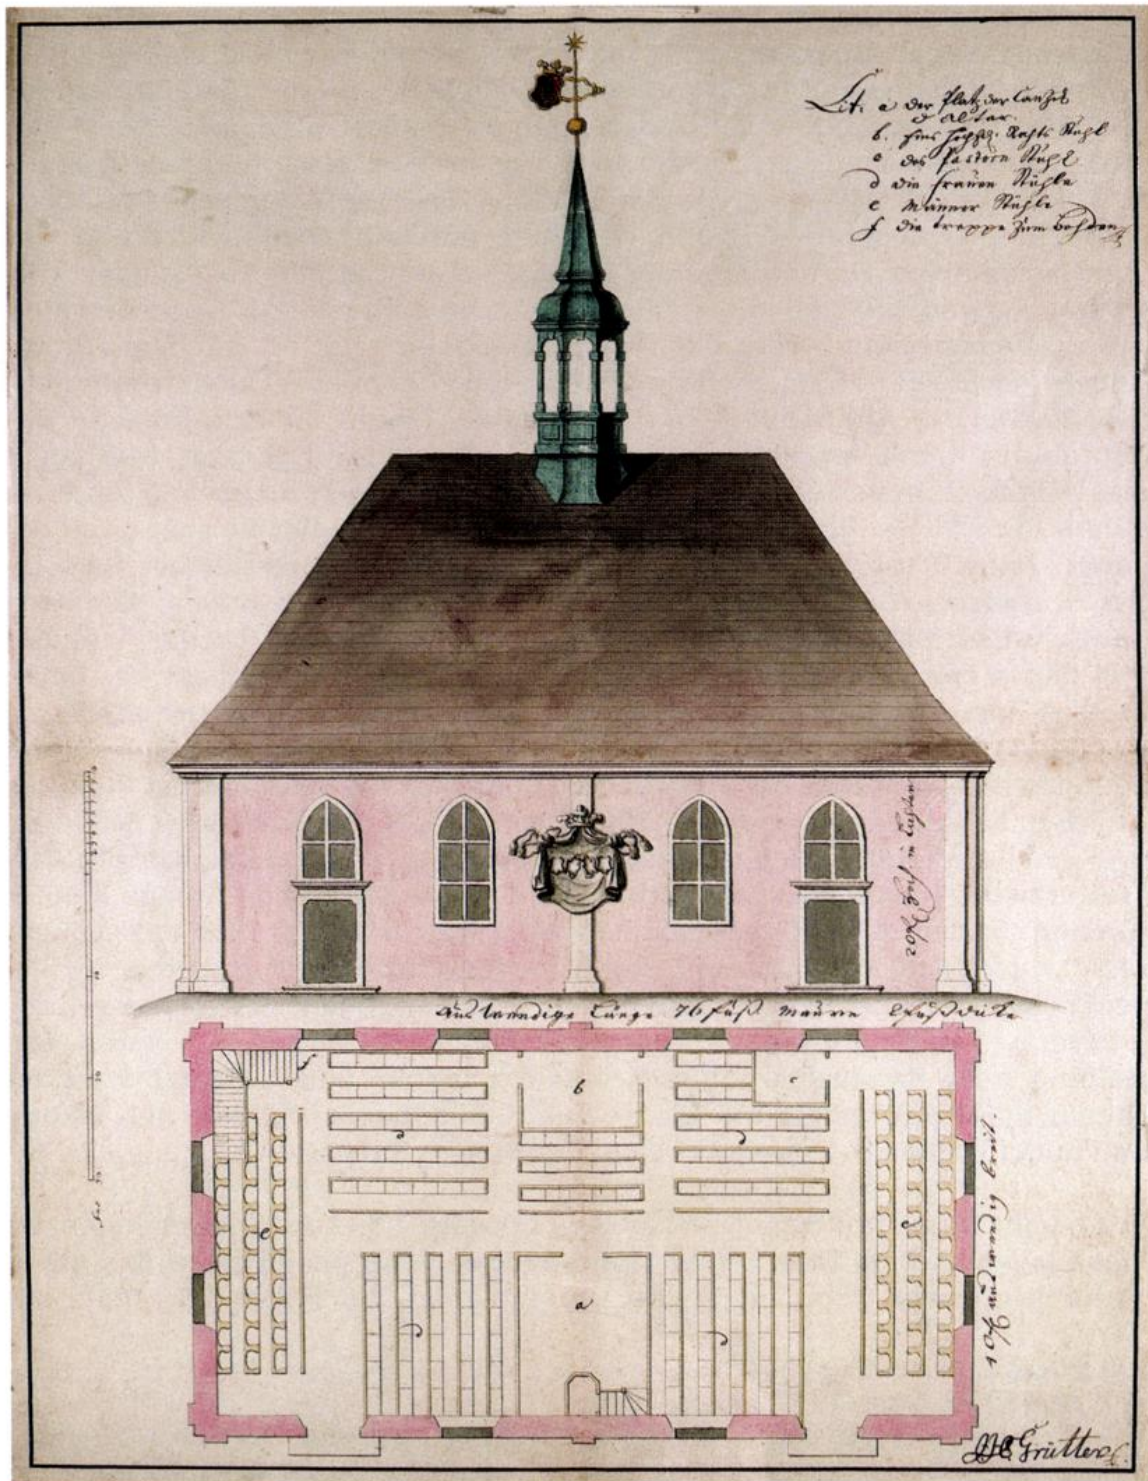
Bauplan von Ratsmaurermeister Grütter für die Rablinghauser Kirche (41 x 51 cm). Der Plan wurde nicht zur Ausführung angenommen, bildete aber das Vorbild für den später ausgeführten Wappenstein. (Foto: StA Bremen)
